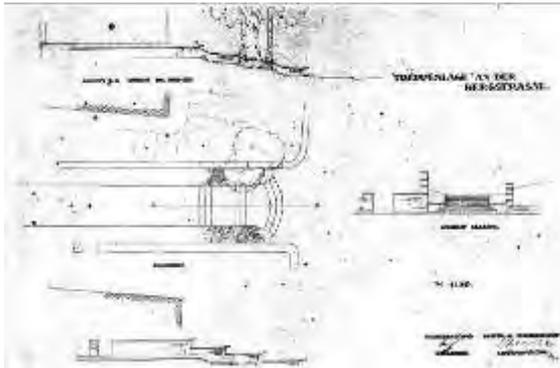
„Treppenanlage an der Bergstraße“, Plan 1958
